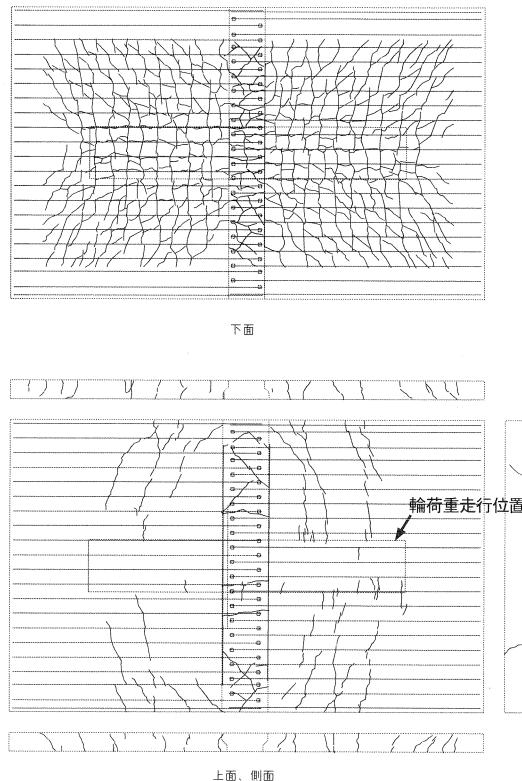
輪荷重走行試験終了時のひび割れ図
